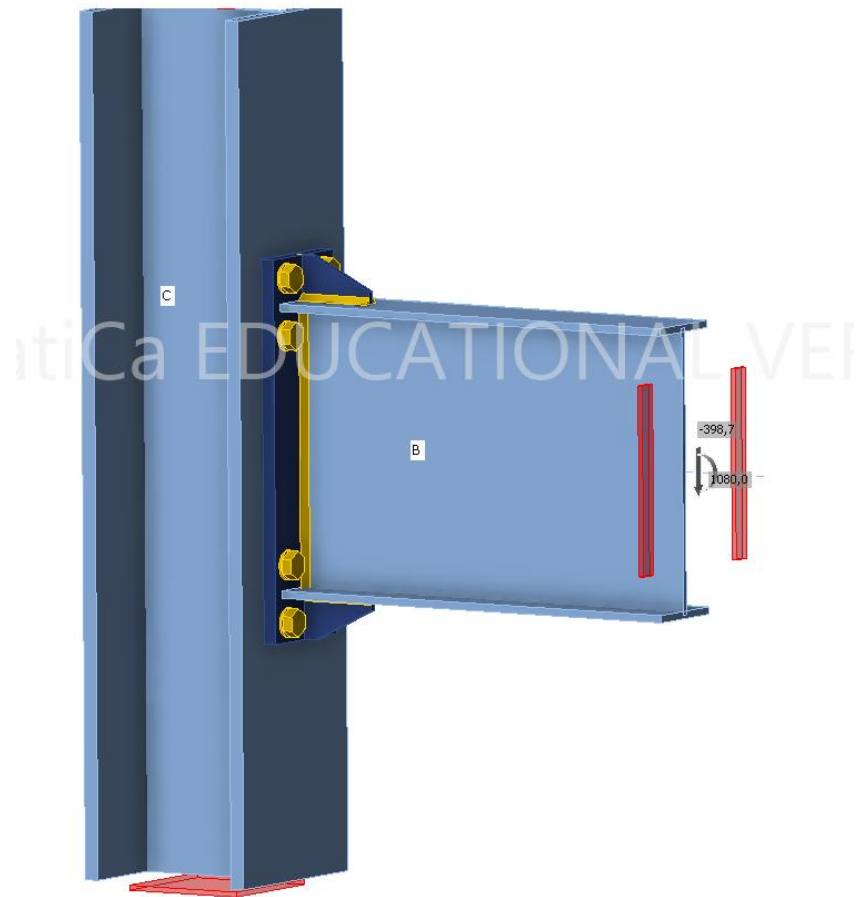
Modelo de conexión de plancha extrema atiesada. Corte en kN y momento en kN-m.
